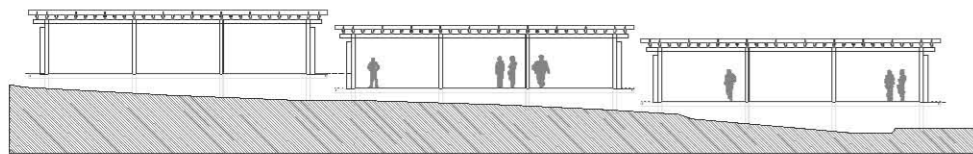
Corte transversal de locales comerciales. El sistema constructivo utilizado como podemos observar no es el apropiado para la zona ni para la pendiente del terreno. En este tipo de proyectos se debería de impulsar mas los sistemas tradicionales para mostrar lo funcionales y eficaces que pueden ser a parte de potencializar el conocimiento adquirido por las culturas de la zona.
